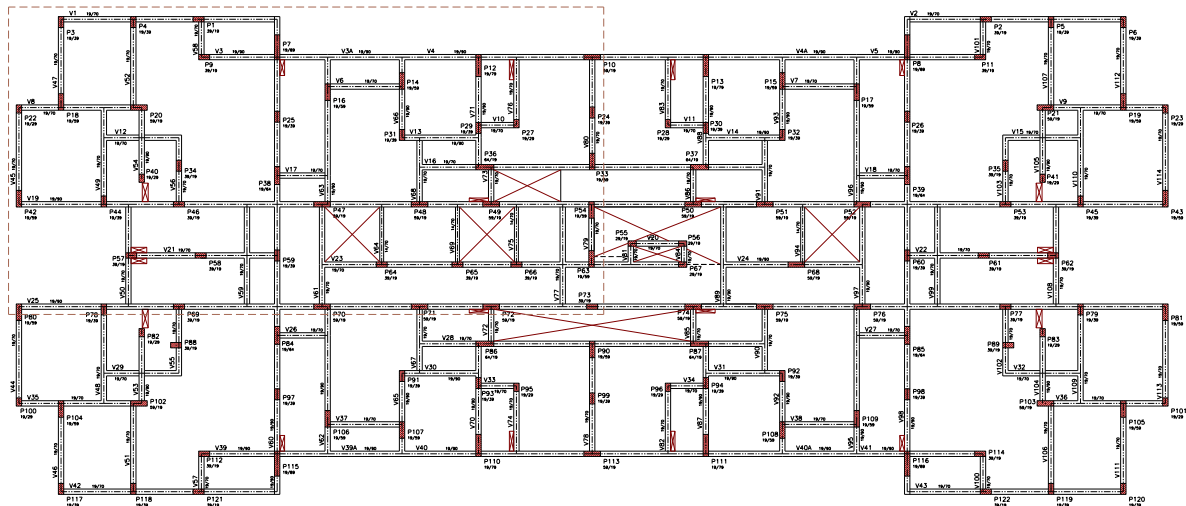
Edifício Vita Belle: planta de formas do 1º pavimento (transição)
